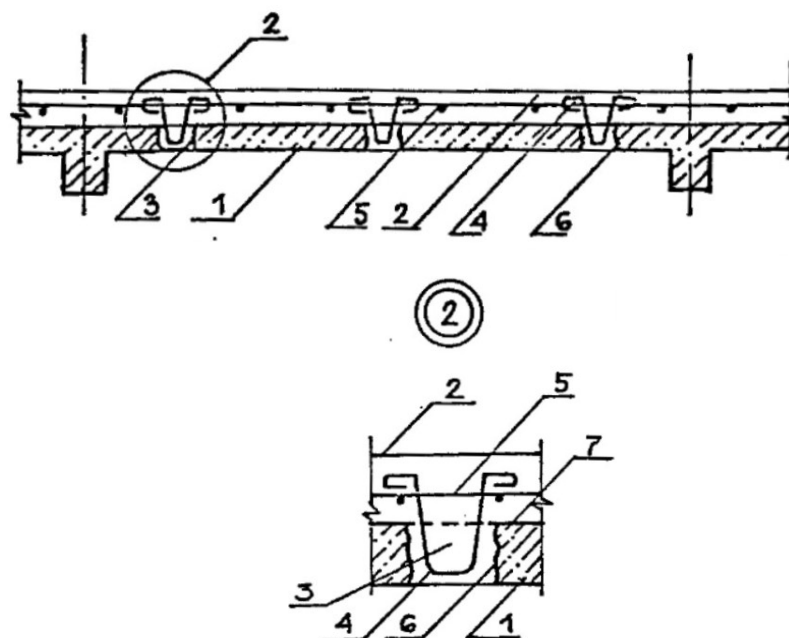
Збільшення несучої здатності плити перекриття нарощуванням зверху зі встановленням залізобетонних шпонок: 1 – плита перекриття, яка підлягає підсиленню; 2 – додавання шару зверху; 3 – залізобетонні шпонки; 4 – вигнуті деталі з арматури А240; 5 – додаткова арматурна сітка; 6 – вибірки 100 на 100 мм розташовані на відстані від 500 до 700 мм у плиті, що встановлюється; 7 - площина плити
